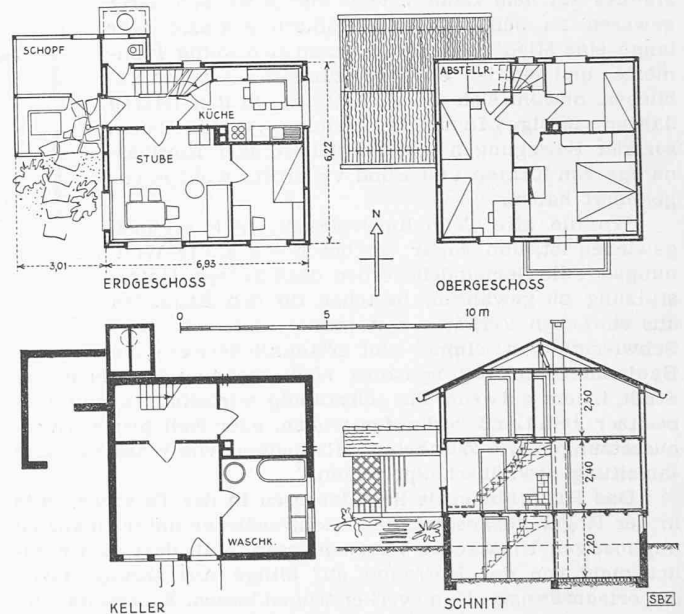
Grundrisse und Schnitt zu Bild 6, Masstab 1 : 250
